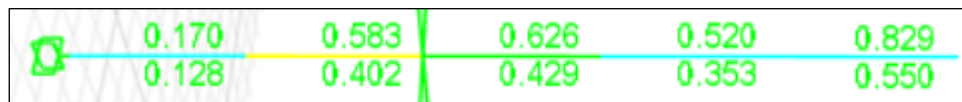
Chequeo columna fuerte-viga débil sistema prefabricado en ETABS®. Fuente: Propia.
